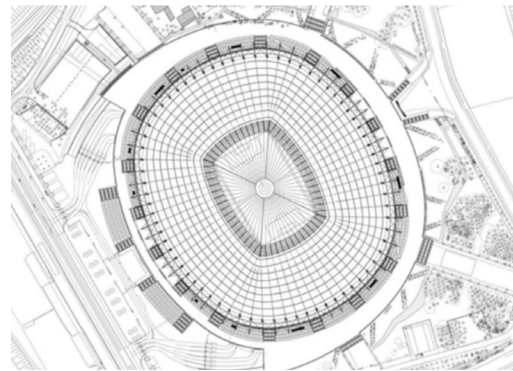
Planta de cubierta del estadio nacional de Varsovia
